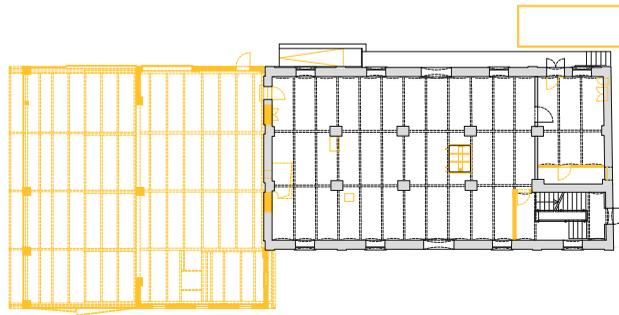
Grundriss Erdgeschoß, Abbruch / Neubau, M 1:500
